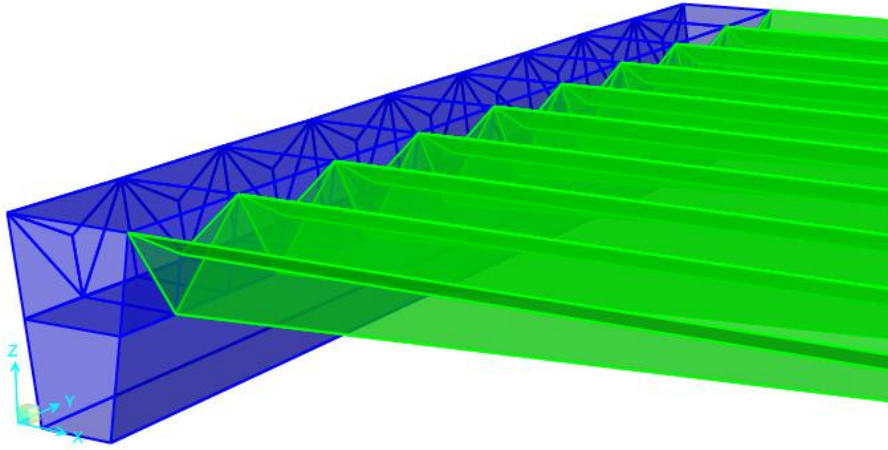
Section de la tôle plissée à l'encastrement avec la poutre-caisson
